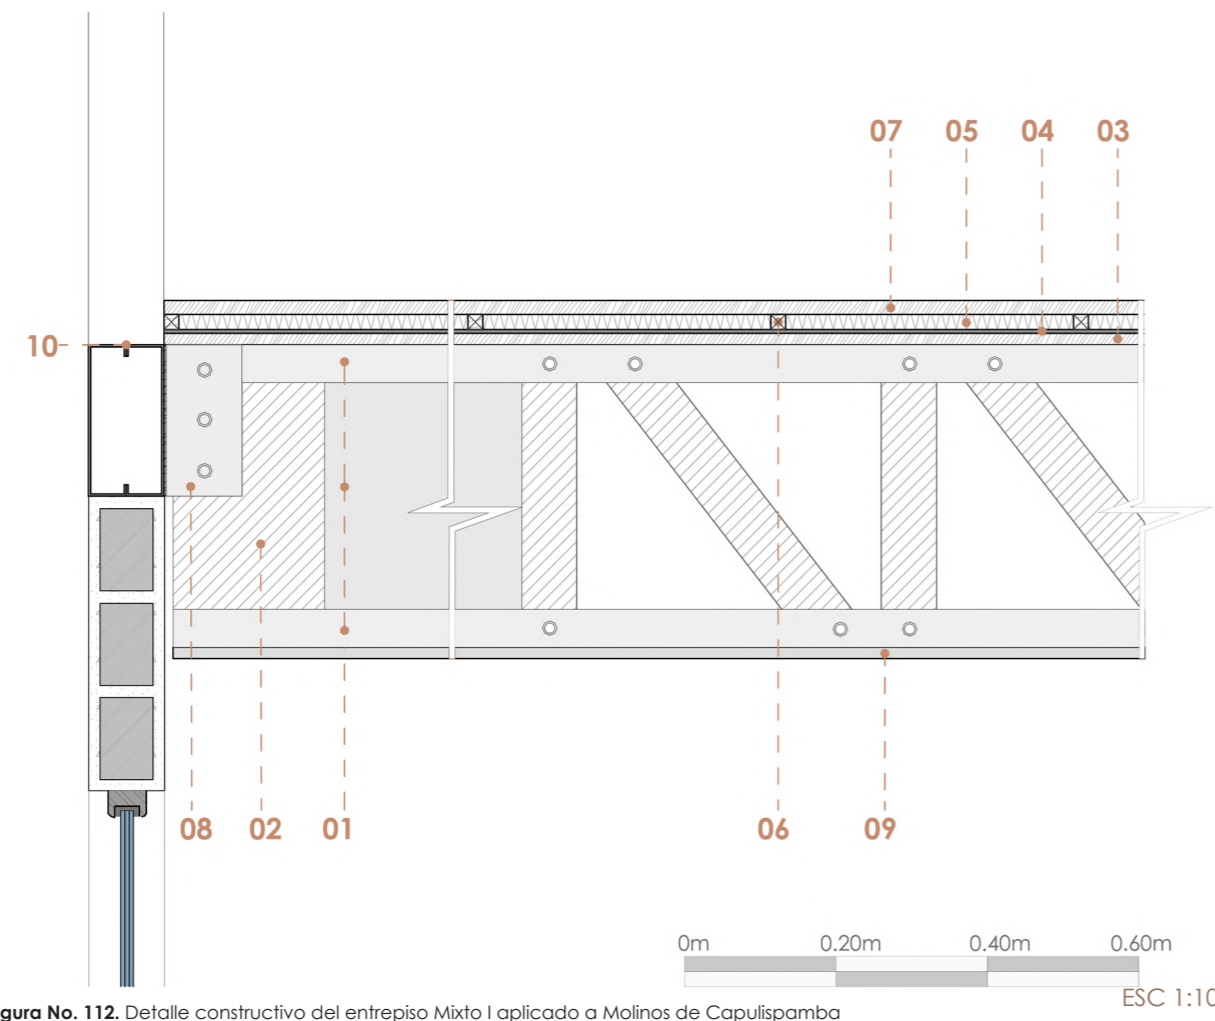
Detalle constructivo del entrepiso Mixto I aplicado a Molinos de Capulispamba
